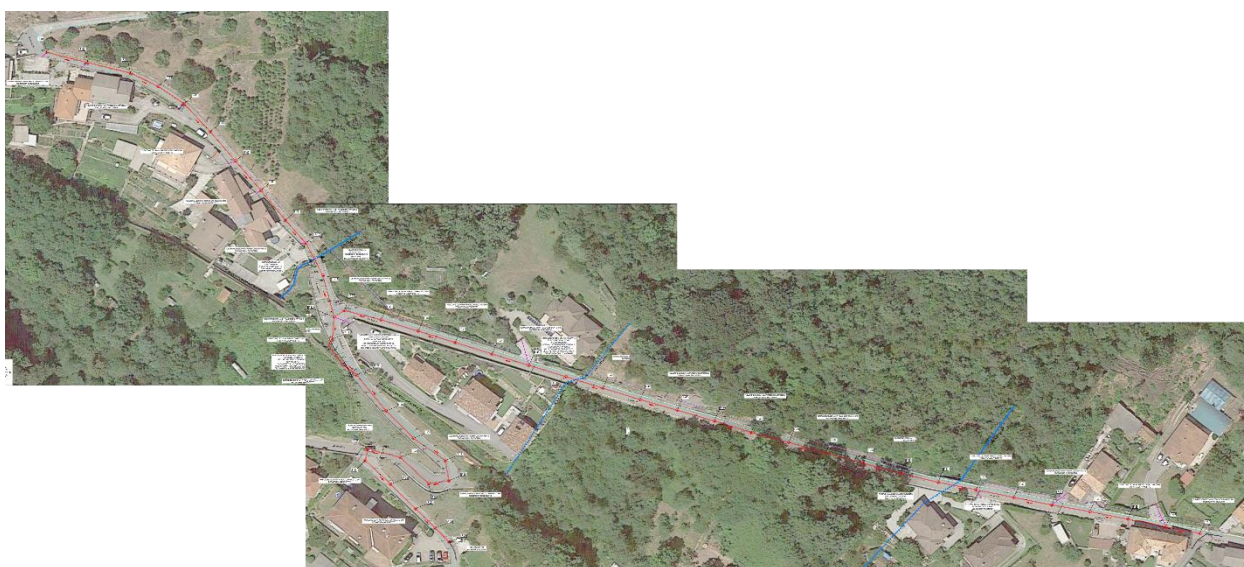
Planimetria con la localizzazione dei lavori in progetto
